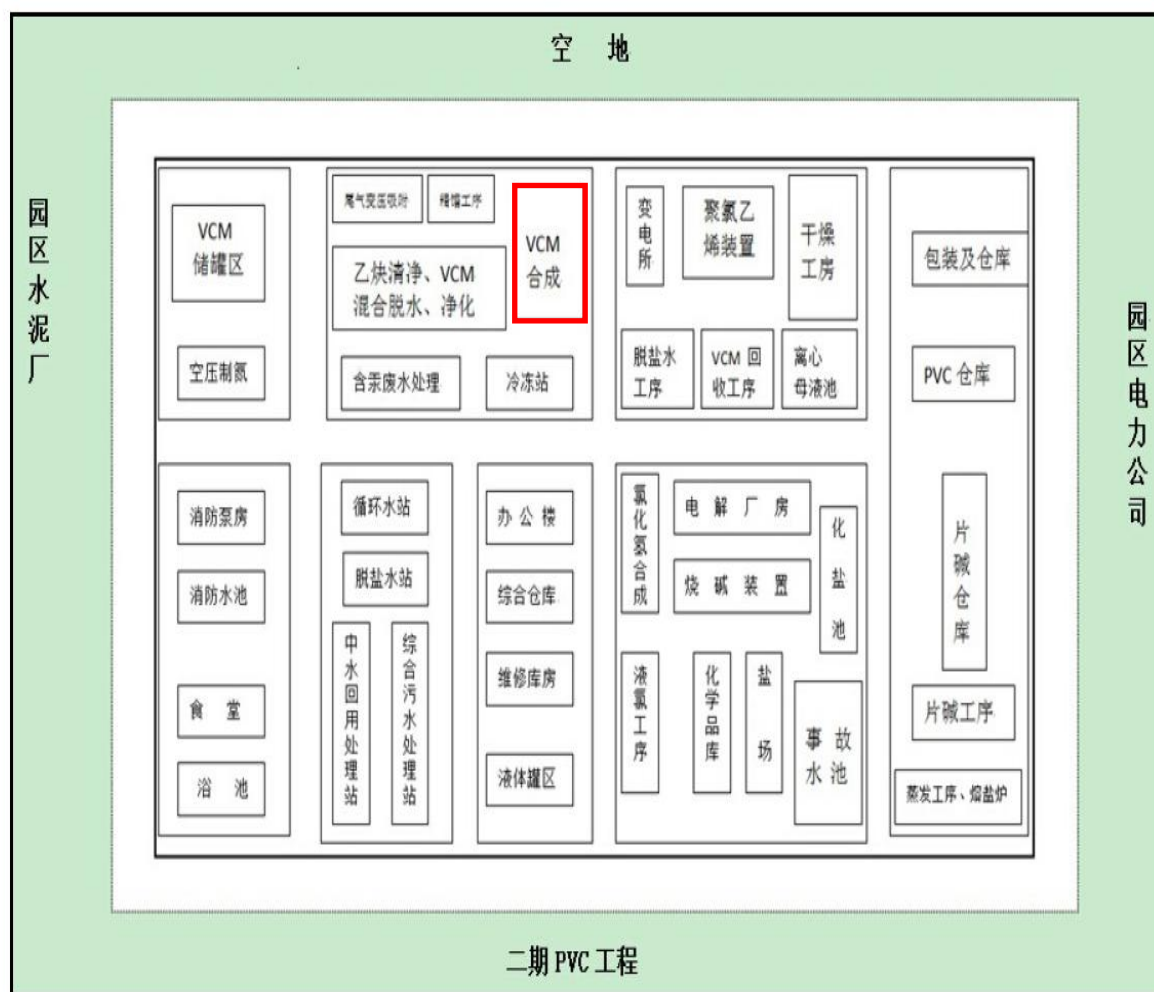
厂区总平面布置图（彩色标记为本次验收部分）
